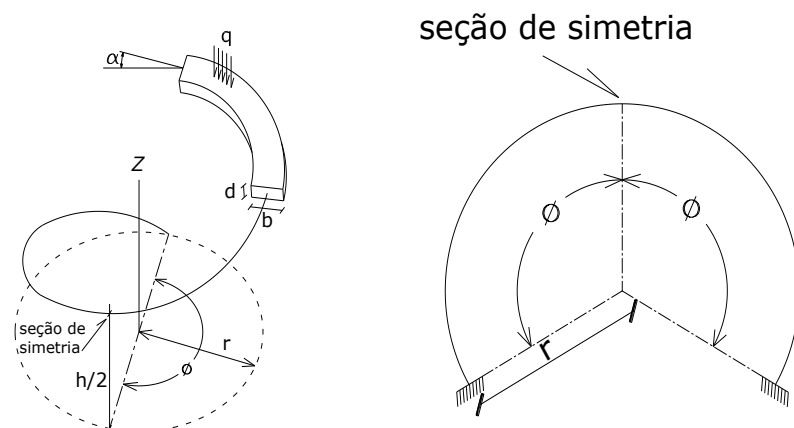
Seção de simetria exemplificada: vista tridimensional (a); em planta (b).
